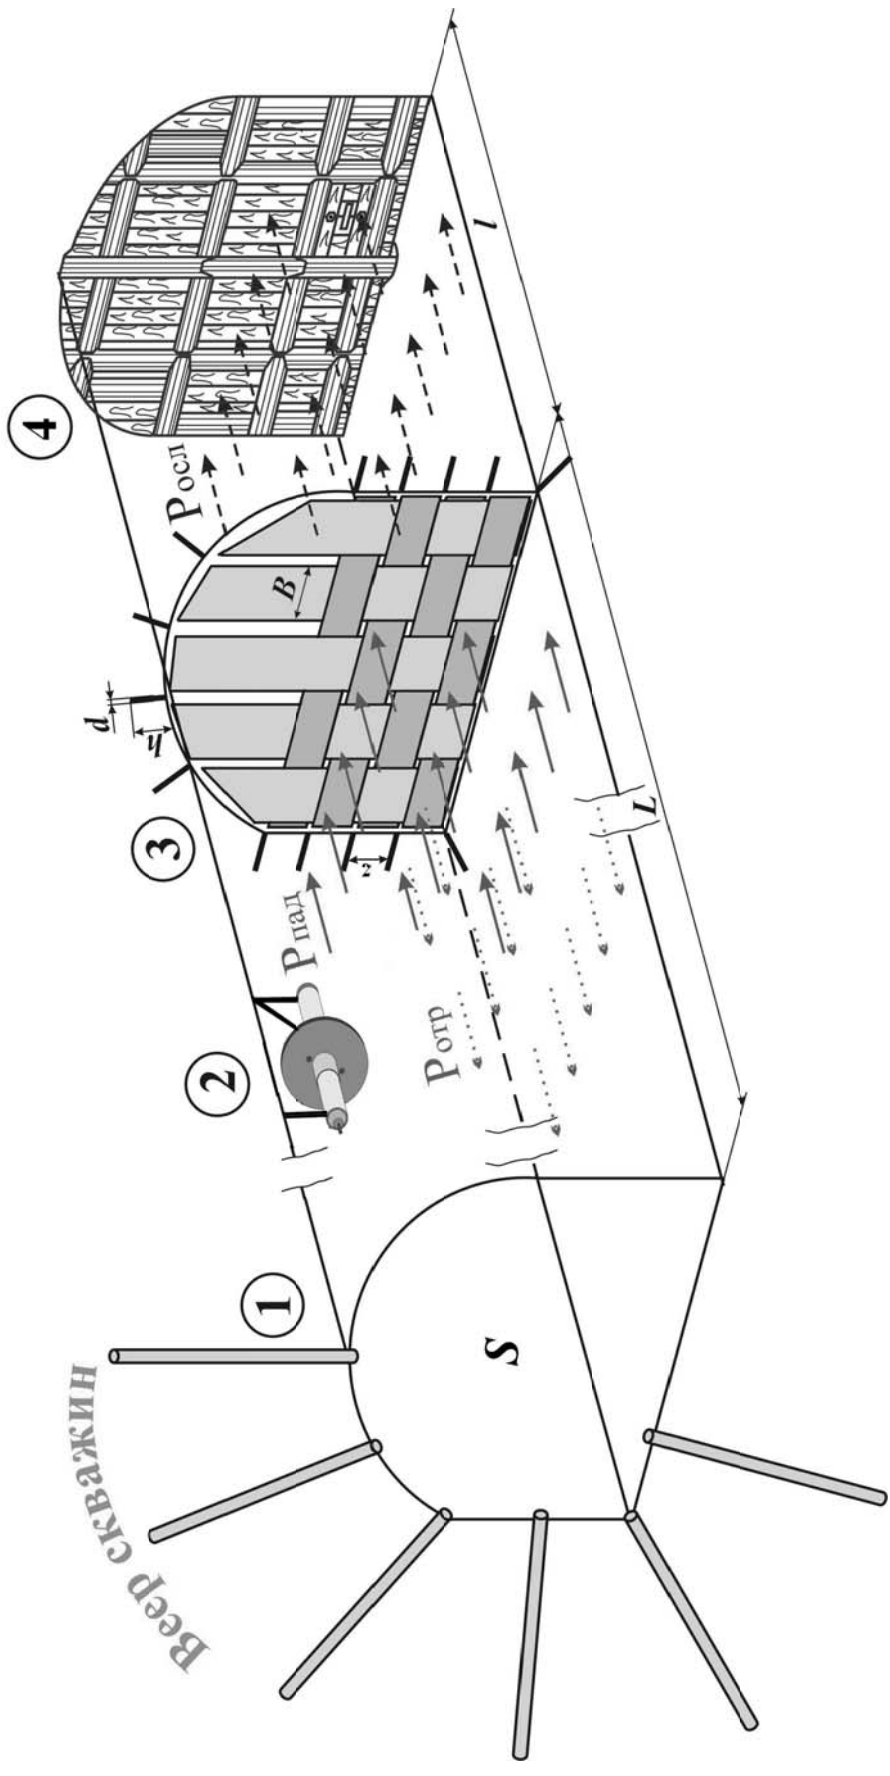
Расчетная схема способа гашения УВВ в подземных горных выработках:
